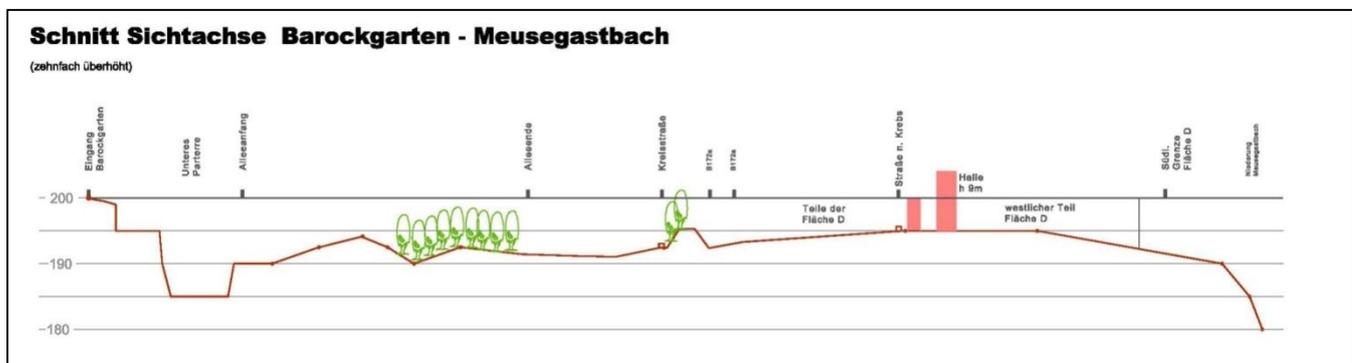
Schnitt Sichtachse Barockgarten – Baumallee – Meusegastbach (zehnfach überhöht, vgl. Plan 4)
